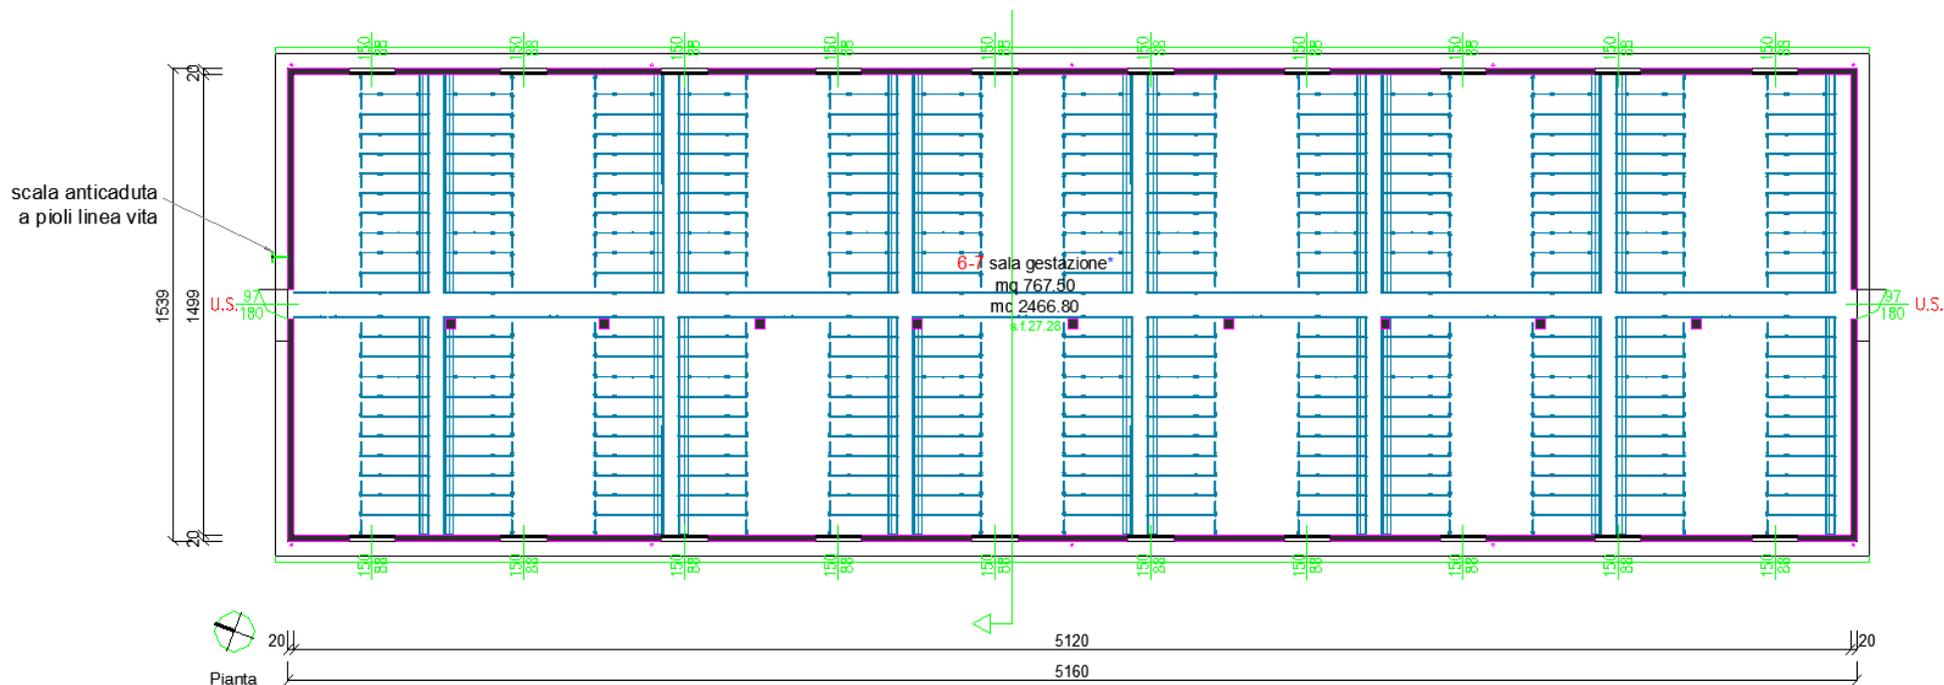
planimetria dei capannoni E5-E6 (fonte: Arch. Bergamo)
